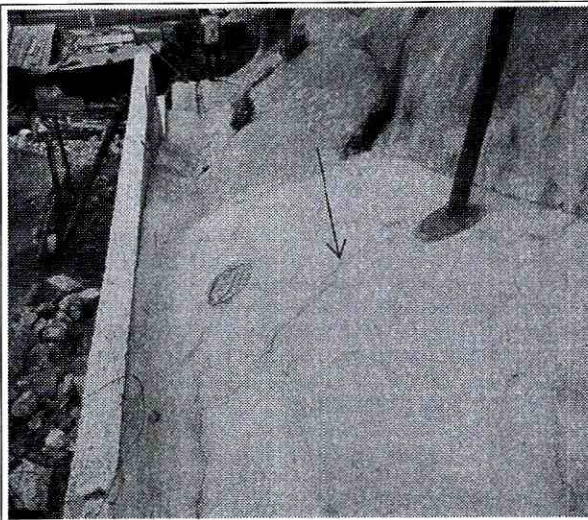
Sistema de drenaje y recubrimiento del talud costado norte
